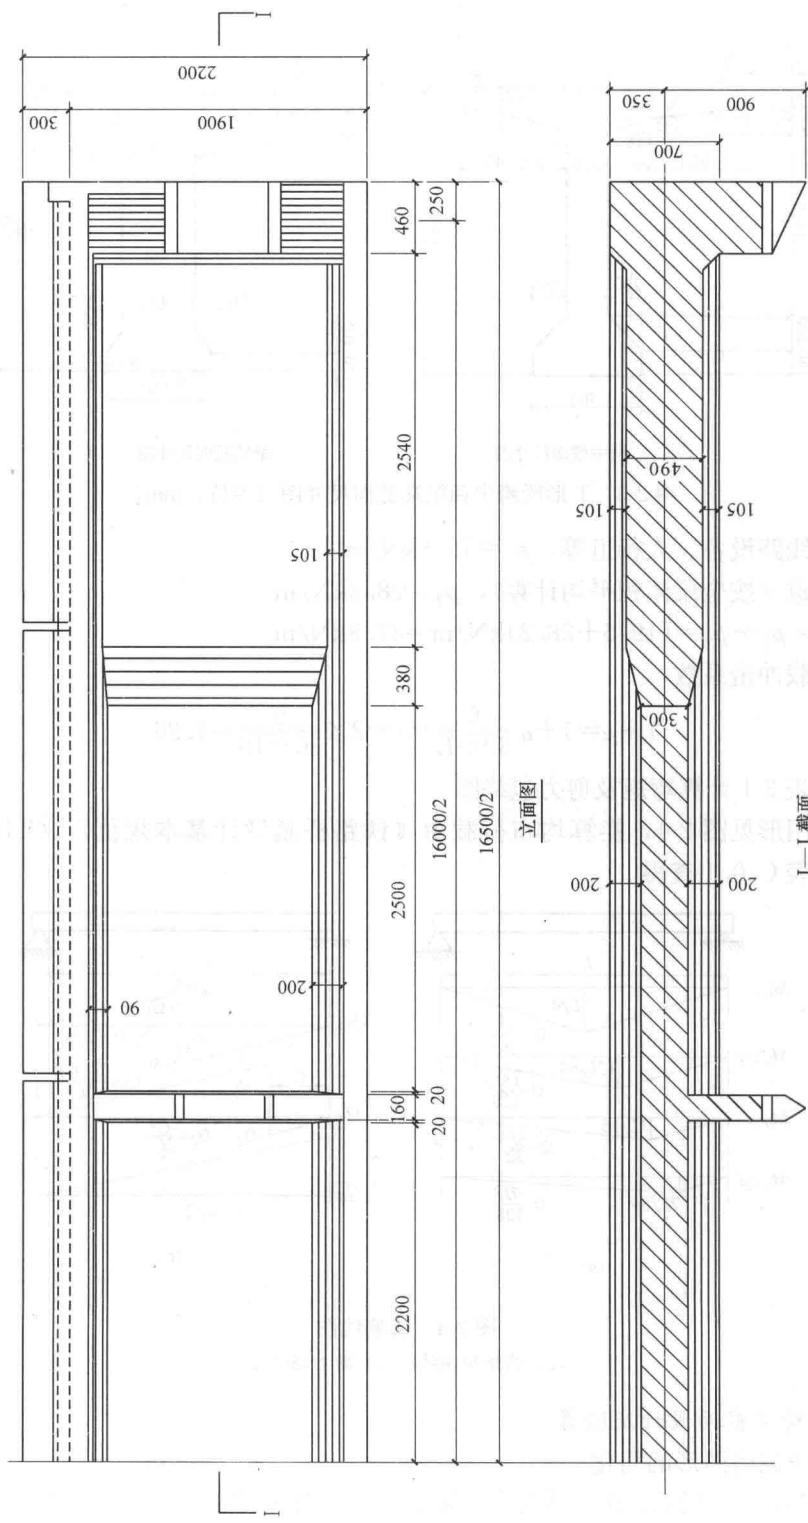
钢筋混凝土梁体结构布置示意图 (单位: mm)
